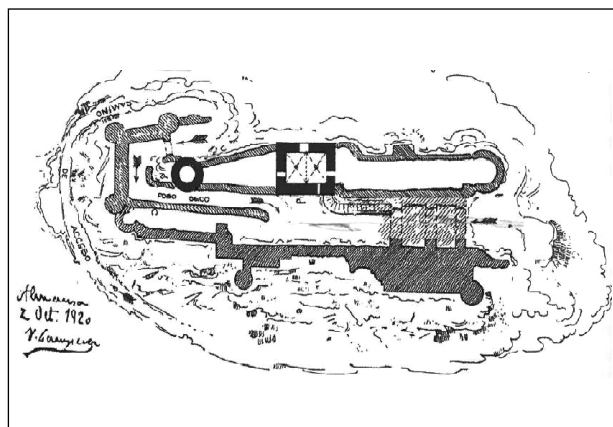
Planta del castillo según Vicente Lampérez 1920 (López Megías & Ortiz López 2006)
